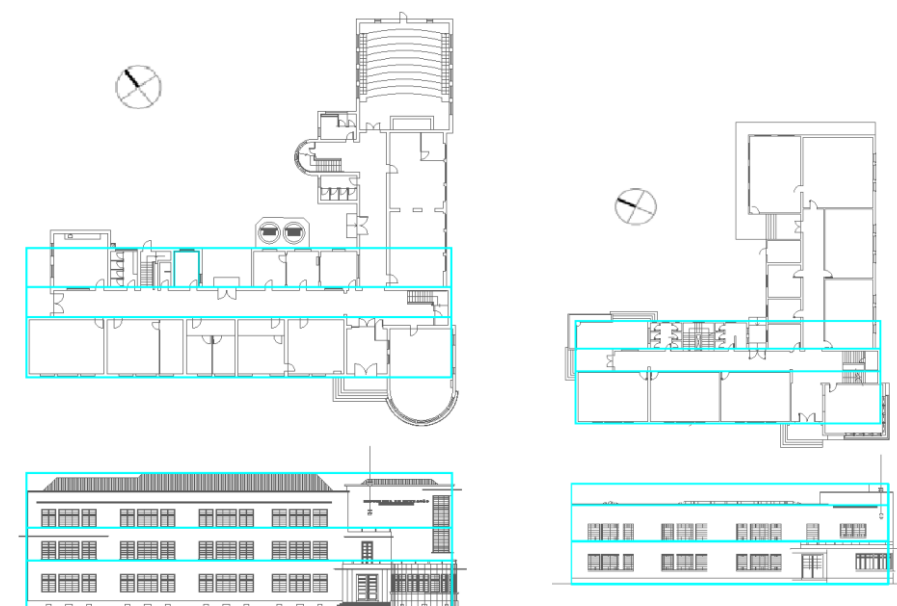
Planta baixa do 1º pavimento e fachada principal dos colégios Assis Brasil e Joaquim Caetano, realce da proporção encontrada em três partes.
